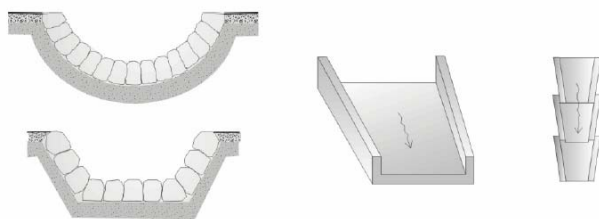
Canalette superficiali in pietrame sbizzato, a sinistra, e ad elementi prefabbricati in calcestruzzo a destra (da ANPA, 2002) -
